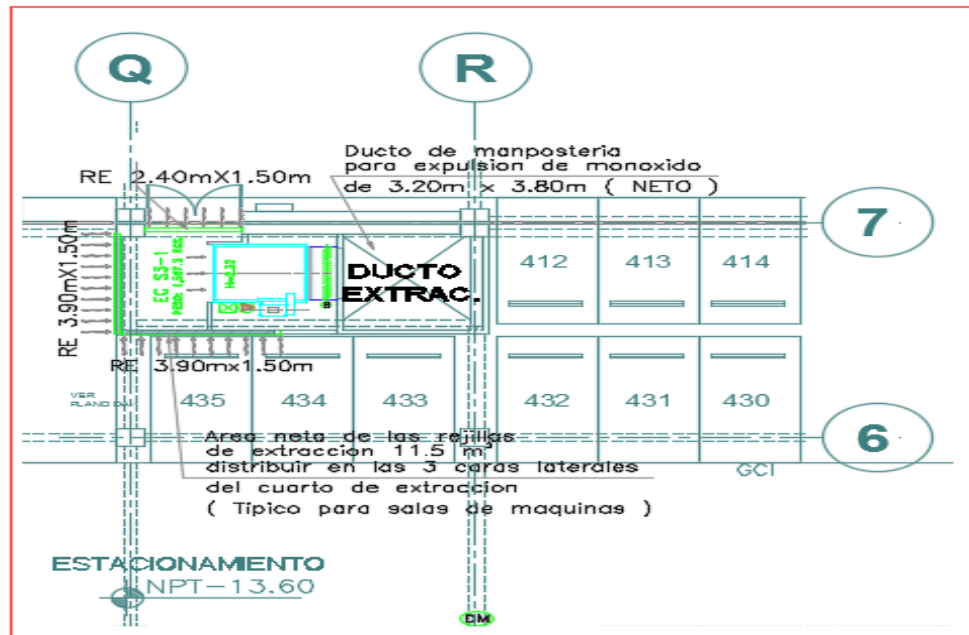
PLANTA PARCIAL 4º SÓTANO, EJES Q-R
